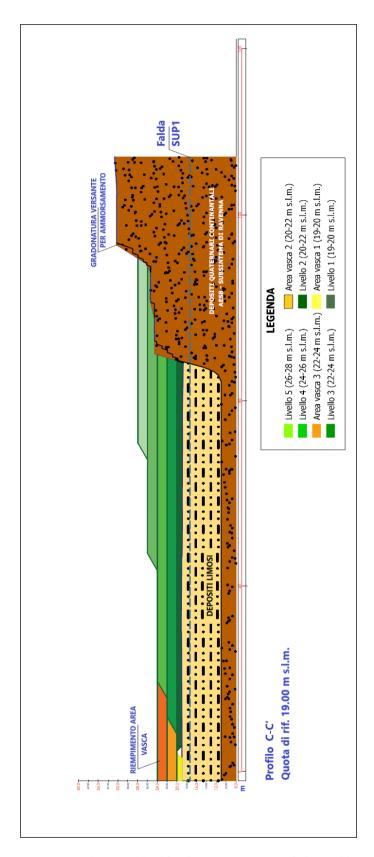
Sezione C- C' sul versante ovest di Cava Olmi
